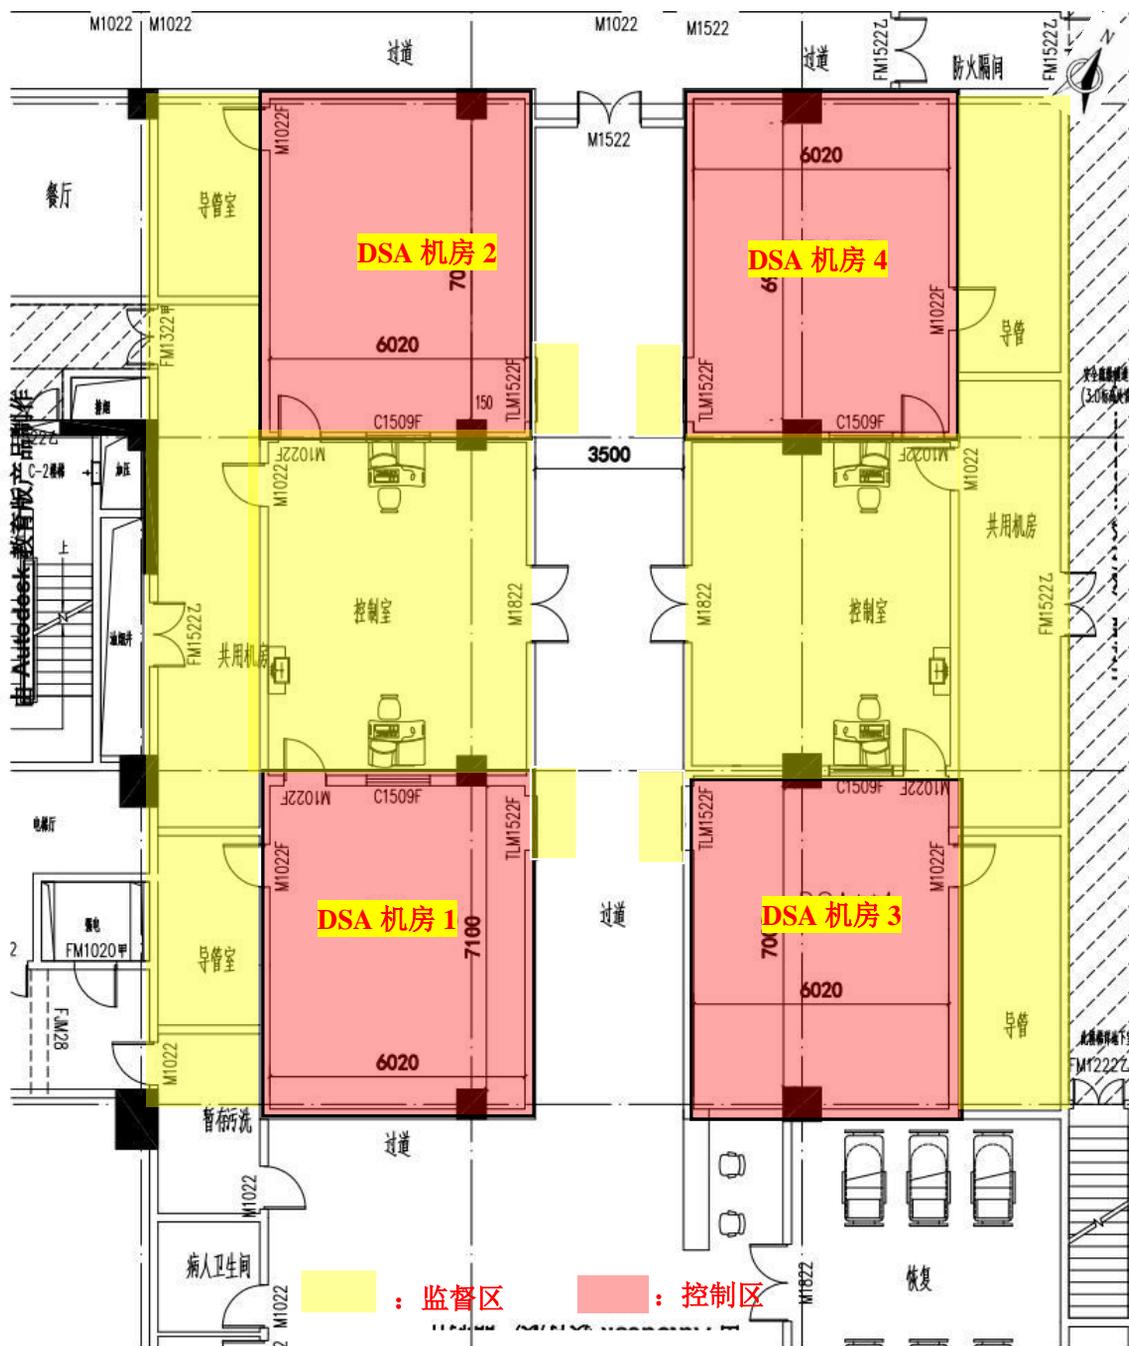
本次验收 2#医疗综合楼北区一层介入中心 1 号~4 号 DSA 机房平面布置图
